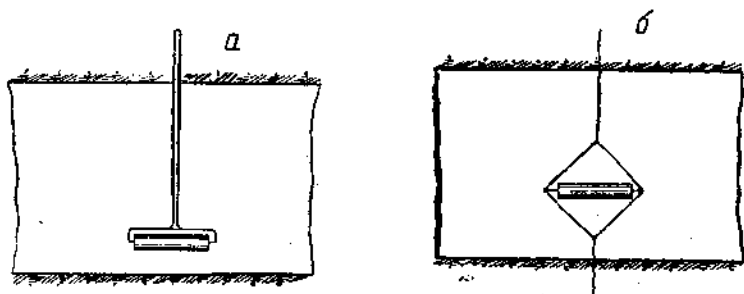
Схема ручного катка: а) для укатки одним рабочим; б) для укатки двумя рабочими.
